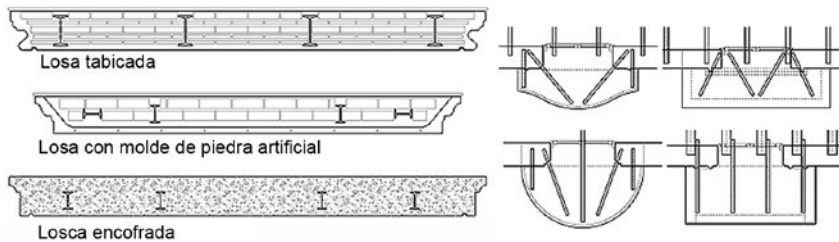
Situación habitual de los perfiles en el interior de las losas construidas con tabicados cerámicos o por un aglomerado de mortero encofrado. Los perfiles se empotran debajo de las jambas de las ventanas o se contraapean en un perfil transversal ubicado en el tramo anexo interior del forjado.
